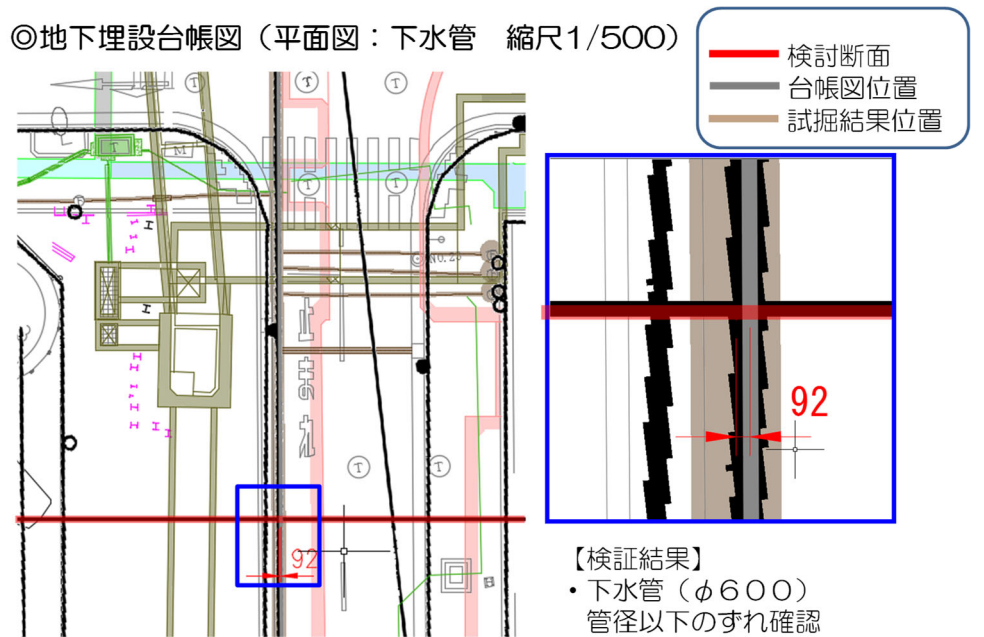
管理図と二次元図面(実埋設状況図:平面図)との検証結果(単位mm)
